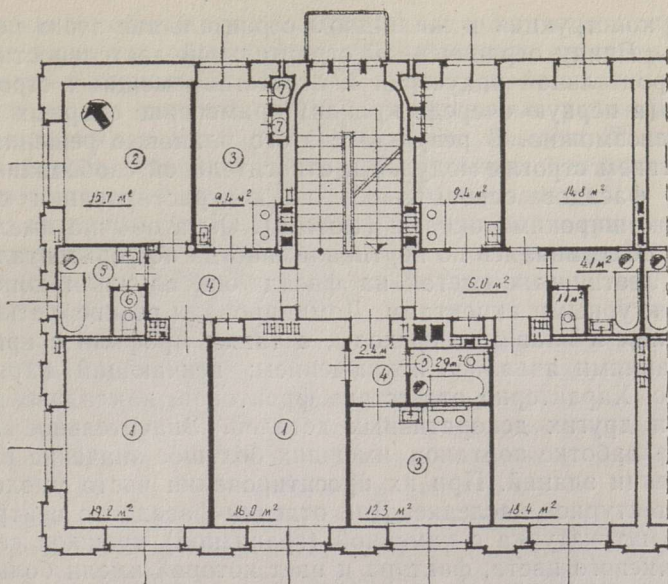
План типового этажа жилого дома по ул. Купдери, 19 (1939 г.): 1 — жилая комната; 2 — спальная; 3 — кухня; 4 — передняя; 5 — ванная; 6 — уборная; 7 — встроенный шкаф.
